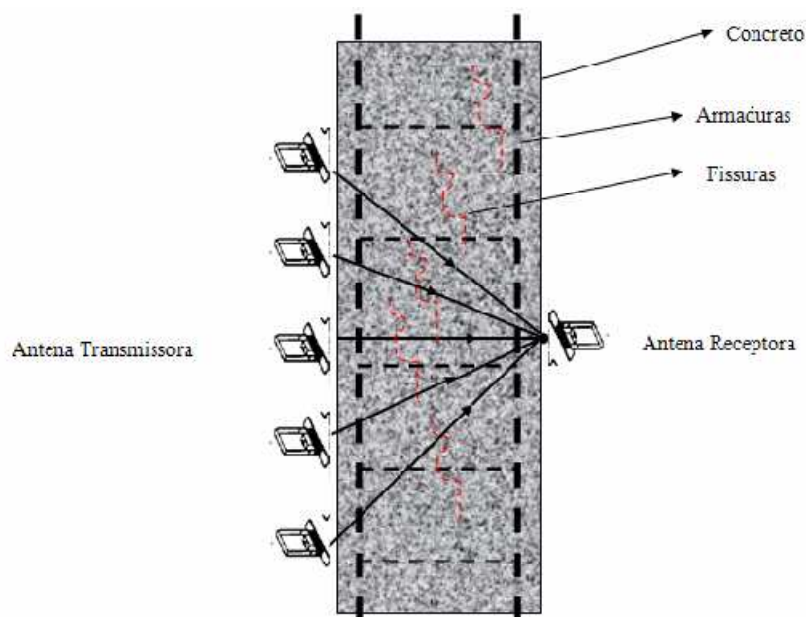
Transiluminação aplicada a uma peça de concreto armado fissurada (Adaptada de ANNAN, 1992).
